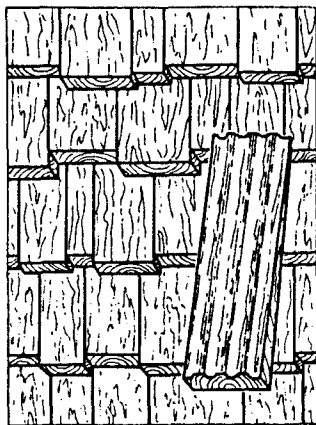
Гонт нешпунтованный и фрагмент кровли
